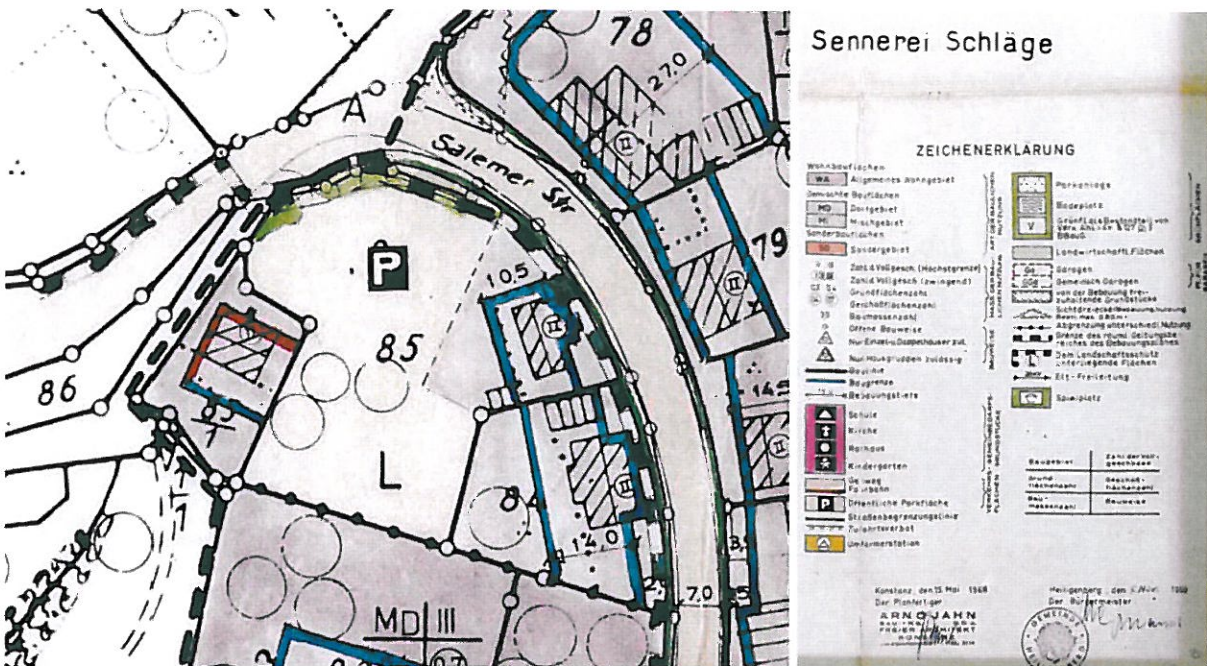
Ausschnitt aus Bebauungsplan Ortsetter, Stand 1968
